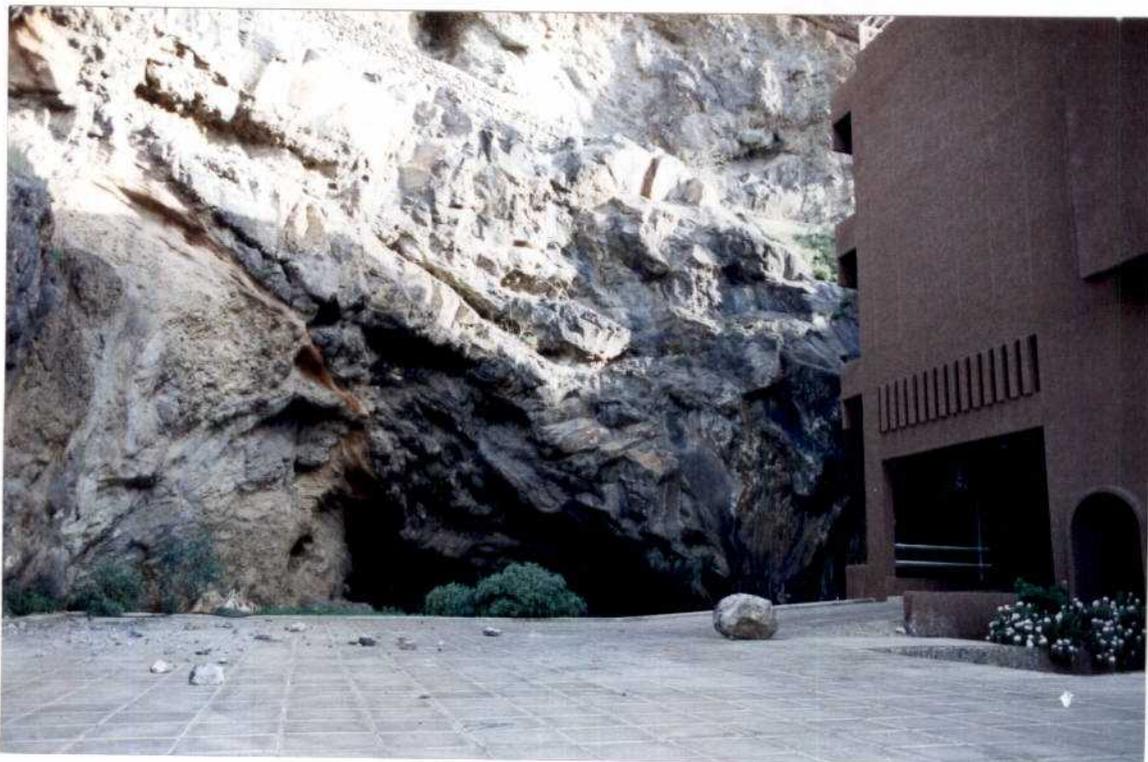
Detalle del impacto de un bloque grande sobre el pavimento.
